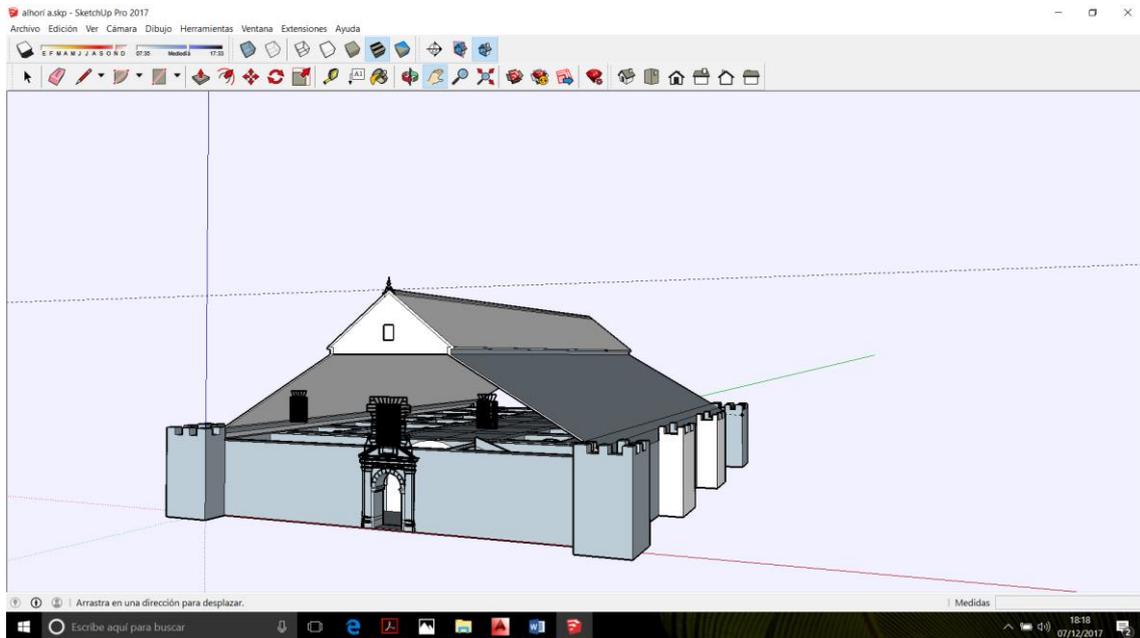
Creación de la planta de primera a partir de la planta baja
